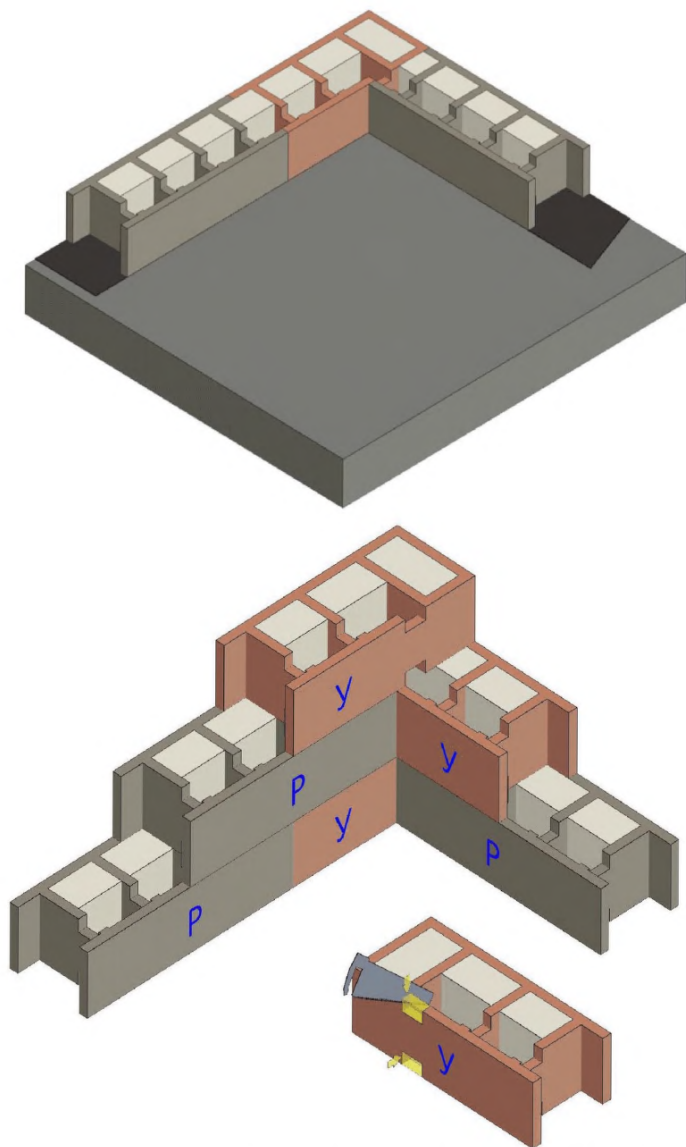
Схемы раскладки и перевязки блоков на угловых участках стен
